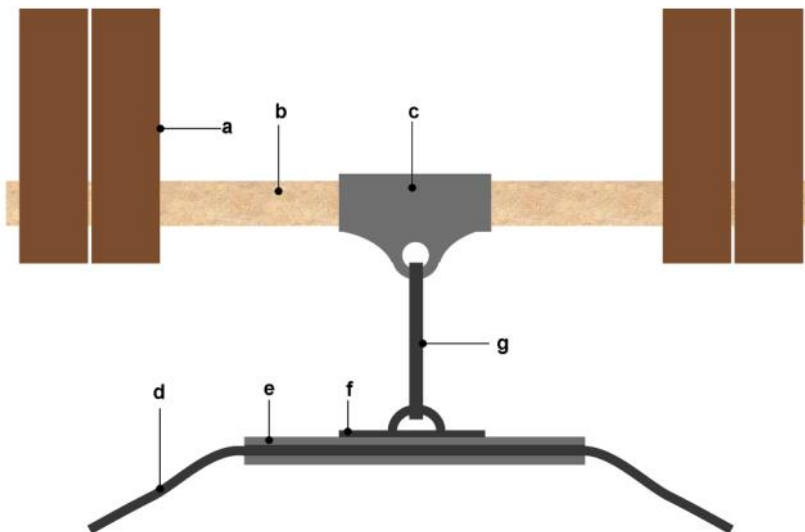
Izquierda: Plano detalle sujeción cubierta interior con abrazadera, pletina y mosquetón.
